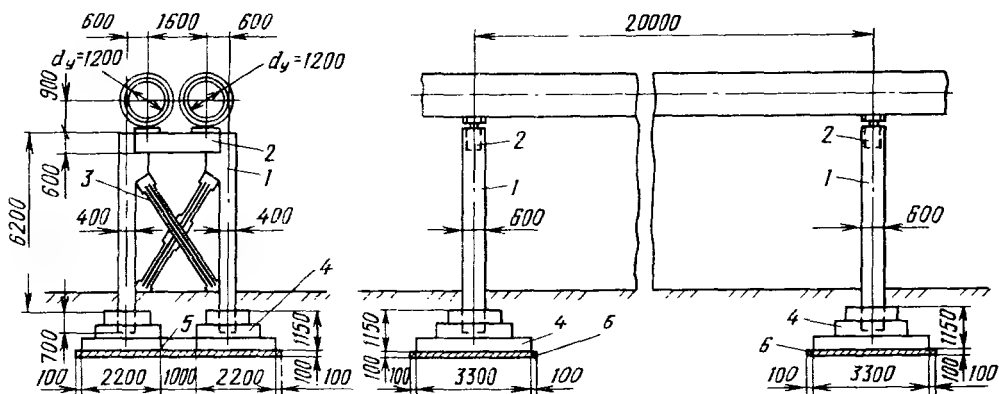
Прокладка трубопроводов на железобетонных мачтах:
